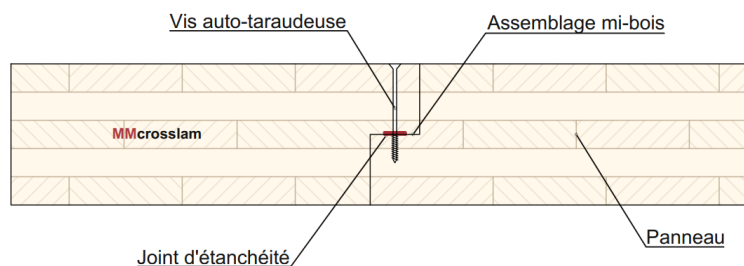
Jonction des panneaux MM crosslam entre eux – Plancher (coupe verticale)
